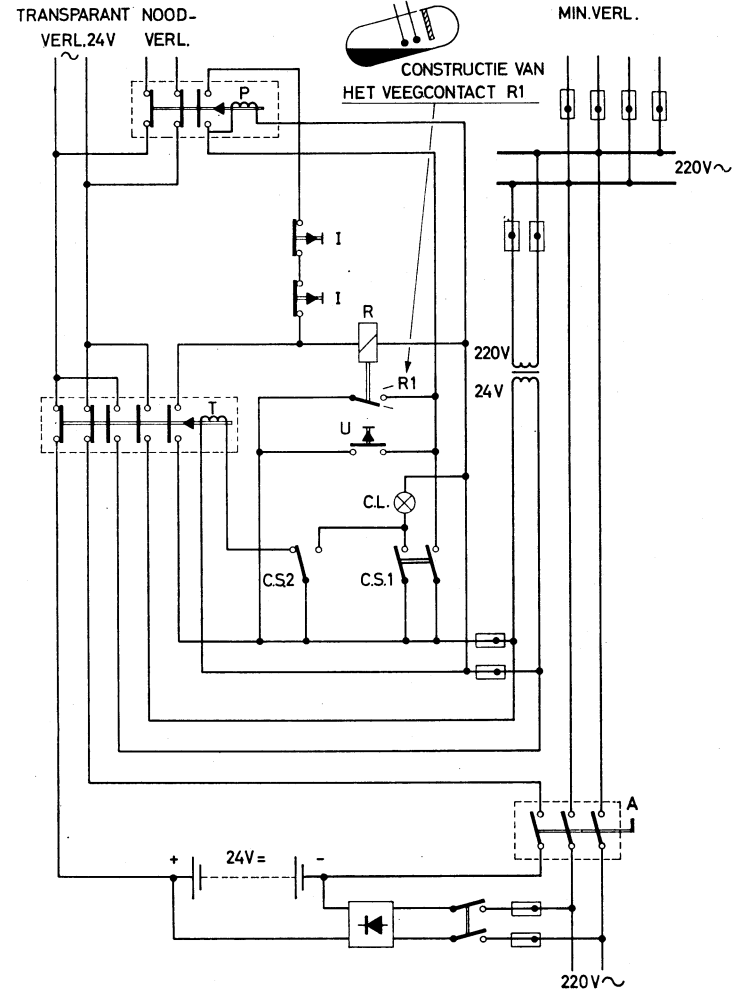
Noodverlichtingsinstallatie voor feestgebouwen
